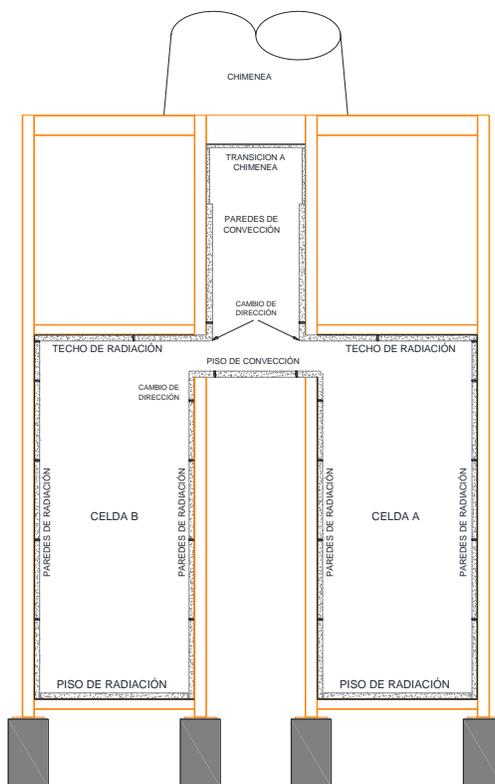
Distribución de juntas para el concreto refractario en las paredes laterales del calentador BA-101 B. Fuente: Planos del proyecto.
